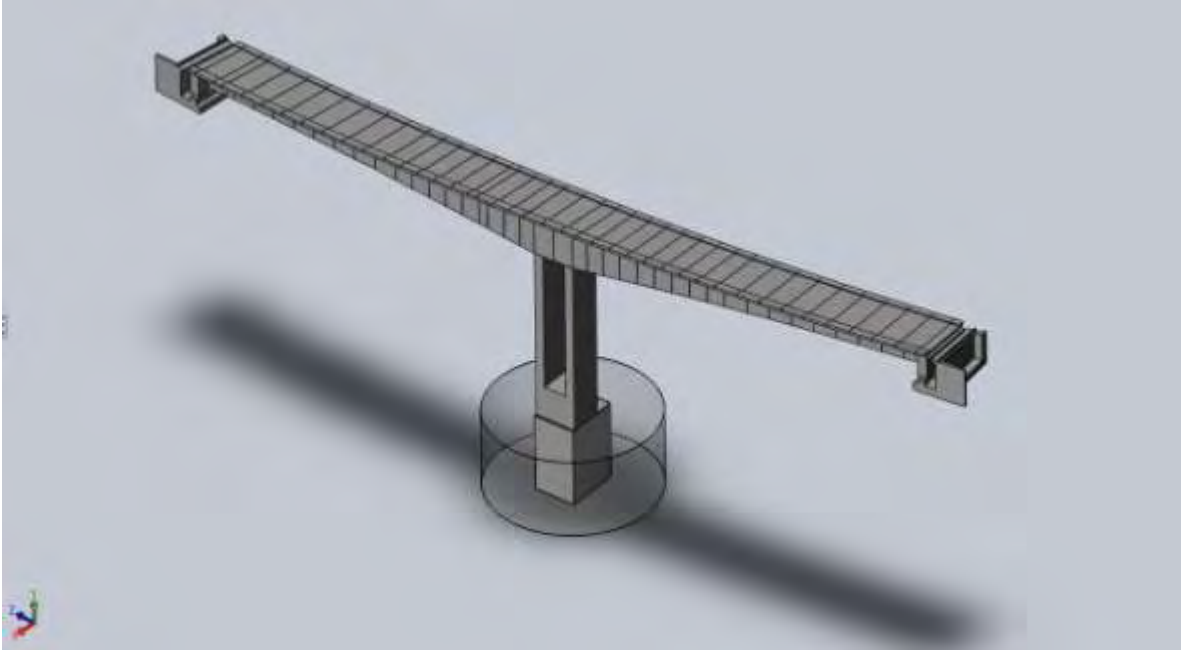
Συναρμολόγηση τελικού Assembly, στάδιο 3
